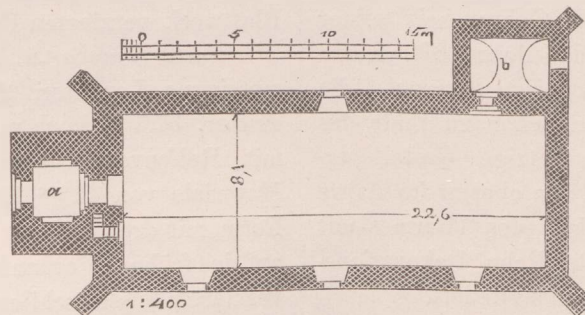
Linowo. Grundriss der Kirche.
